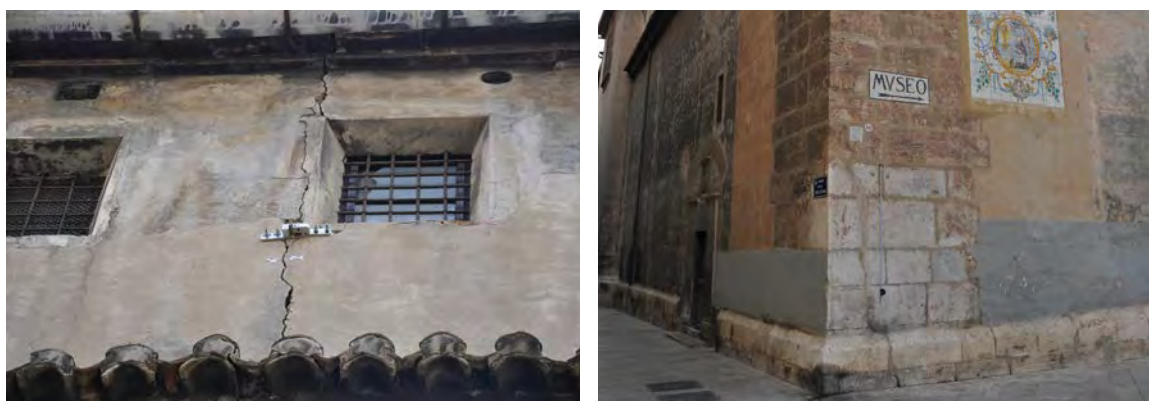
Fisura en la fachada oeste y en la esquina SW.
